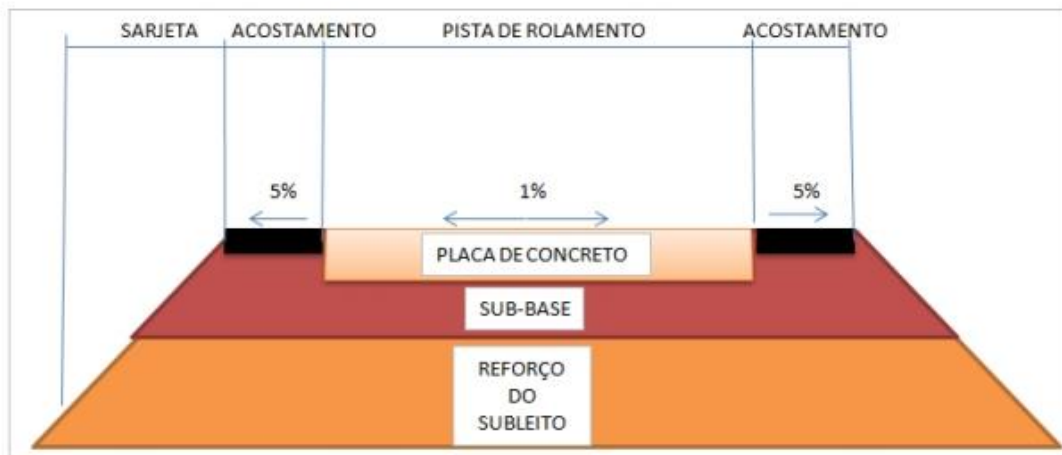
Seção típica de pavimento rígido (Helene *et al.*, 2017).
